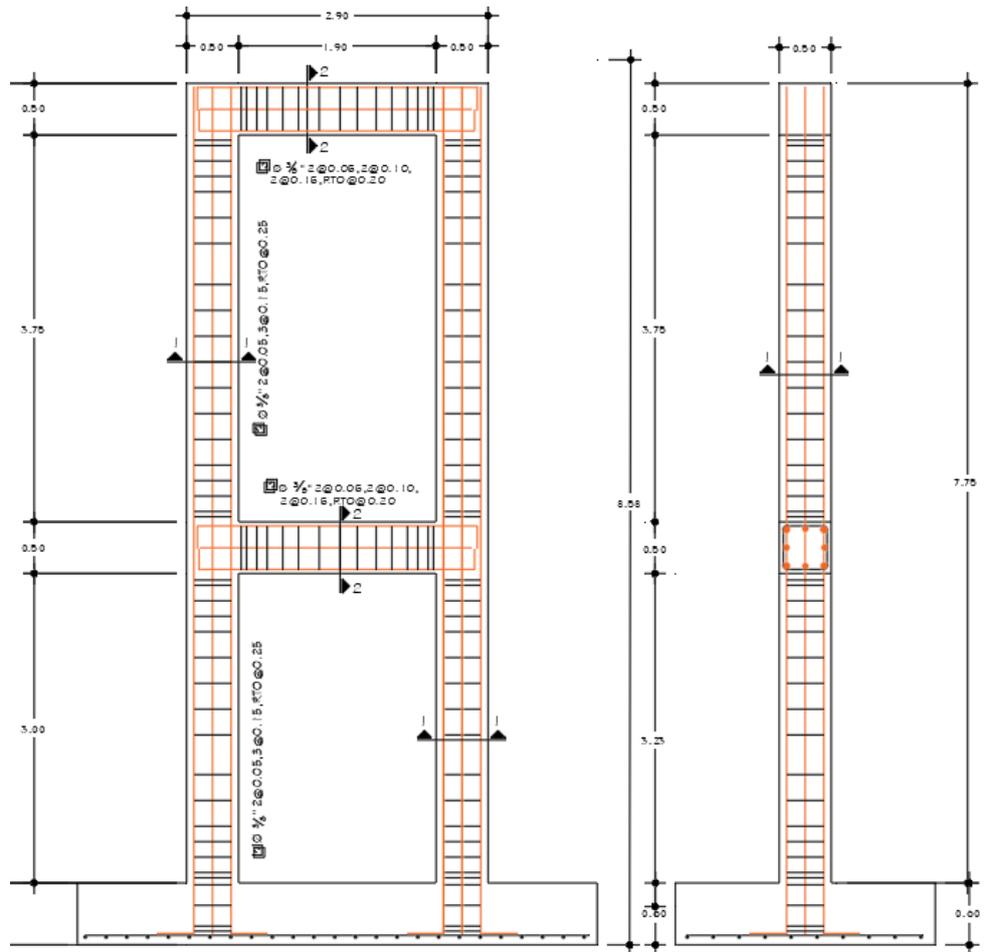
Estructuras de Suspensión (Fuente: Propio)
